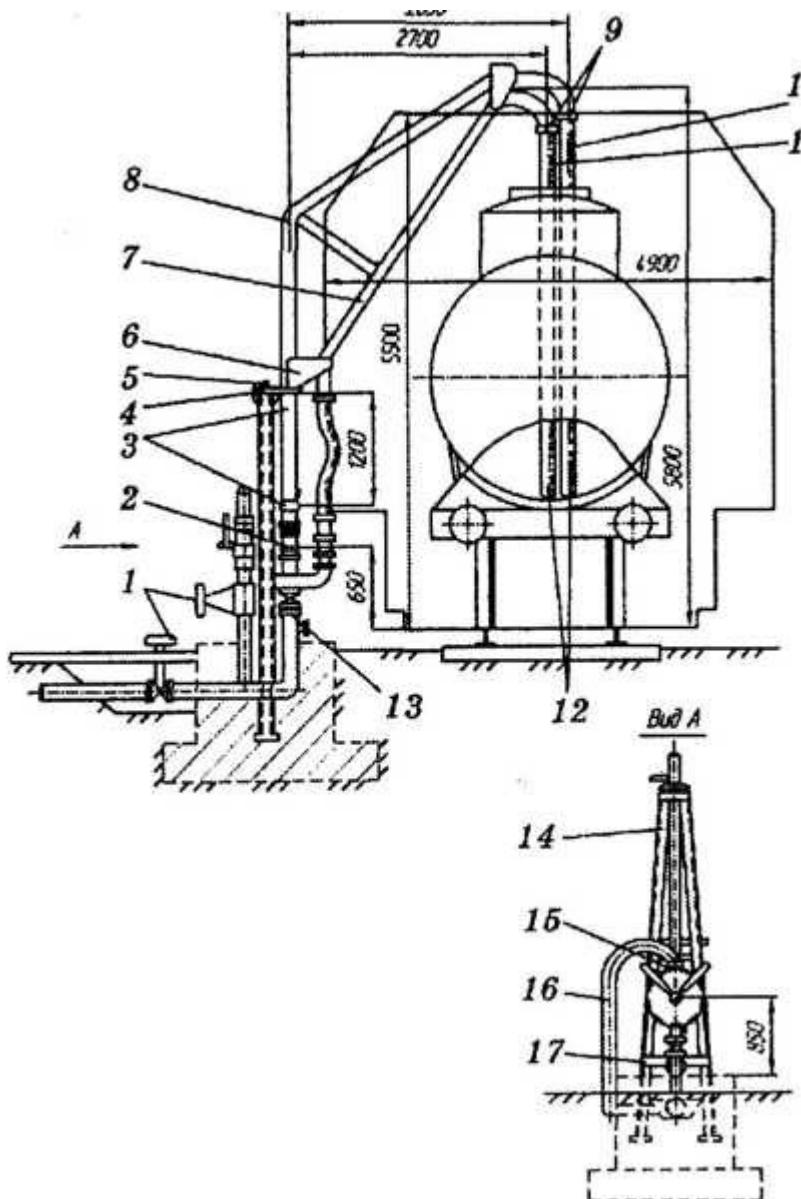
Одиночный стояк с ручным насосом: 1 - задвижка; 2 - поворотный сальник; 3 - хомуты; 4 - накладка; 5 - стопор ограничителя; 6 - косынка; 7 - зачистная труба; 8 - стояк; 9 - соединение рукавов с трубами; 10, 11 - гибкие рукава; 12- наконечник; 13 - патрубок для нижнего слива; 14 - опорная стойка; 15 - ручной насос; 16 - труба; 17 - накладка; 18 - ограничитель; 19 - рукоятка для поворота стояка; 20 - вентиль
